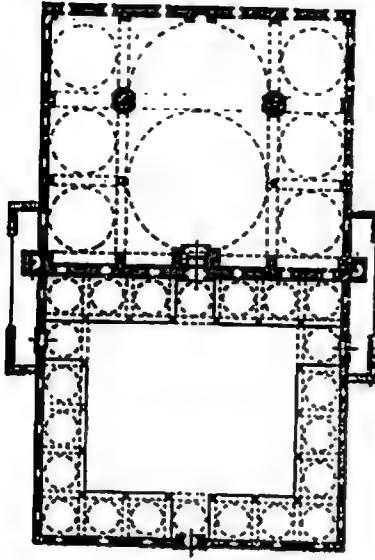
المسقط الأفقي لجامع محمد مسيح باشا .
